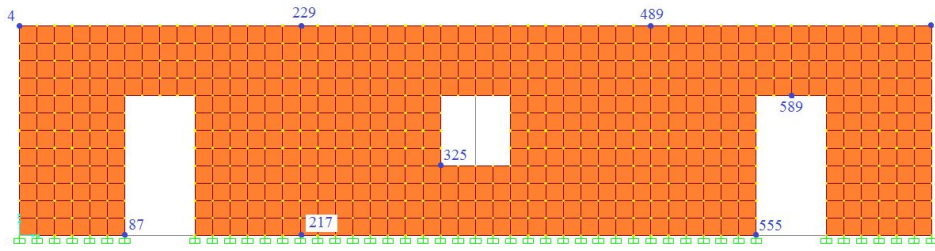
Construção 4.2, rotura por compressão (1)
